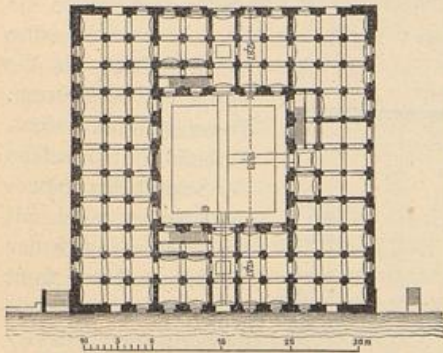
Hauptlagerhaus des Packhofes. Grundriss.
